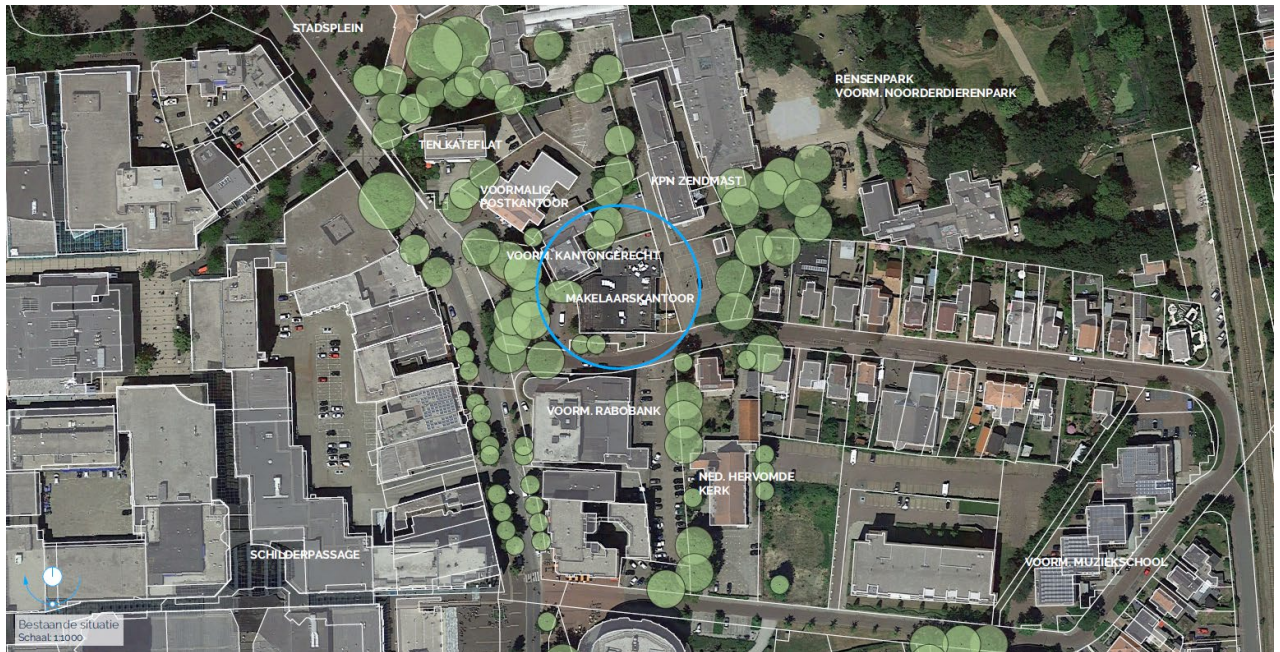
Schetsplan woningbouwproject Sterrenkamp 1, Emmen
